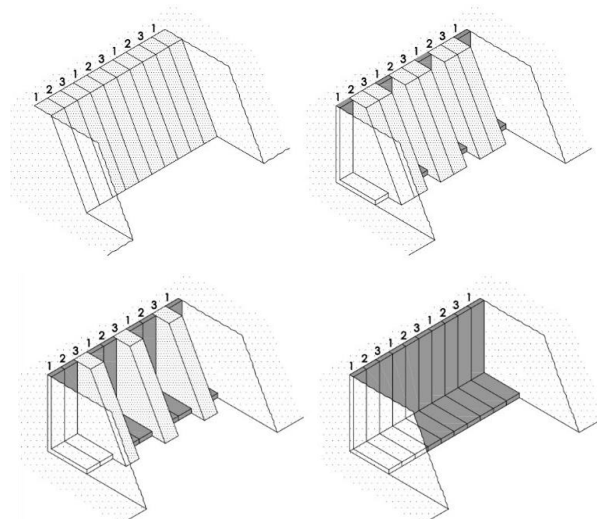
Faseamento construtivo do muro de contenção periférica [4]
